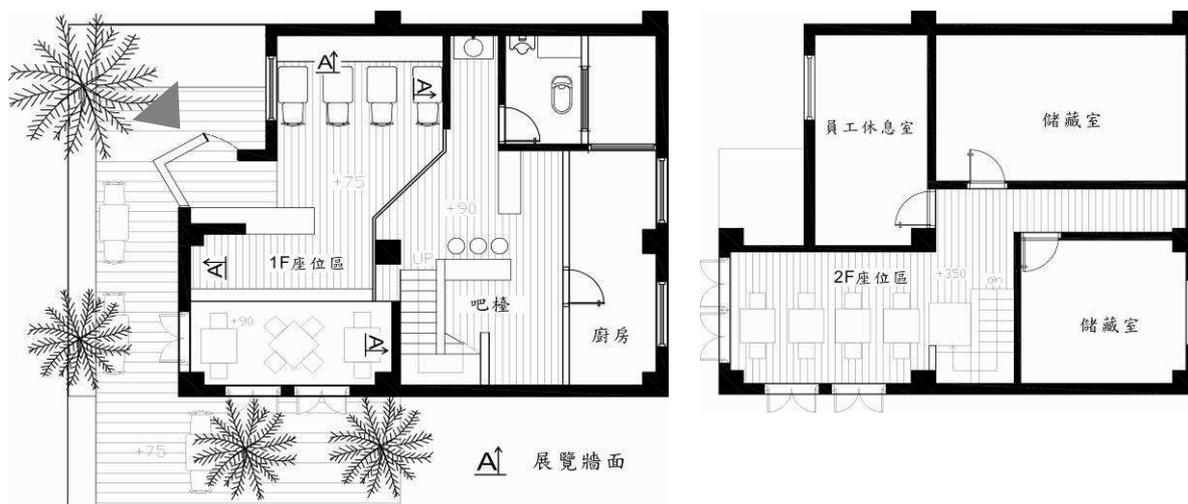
4 胡同左：1F 平面圖 右：2F 平面圖
